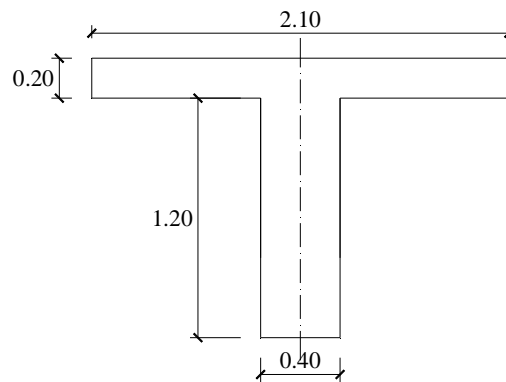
Dimensiones de la vigas.
